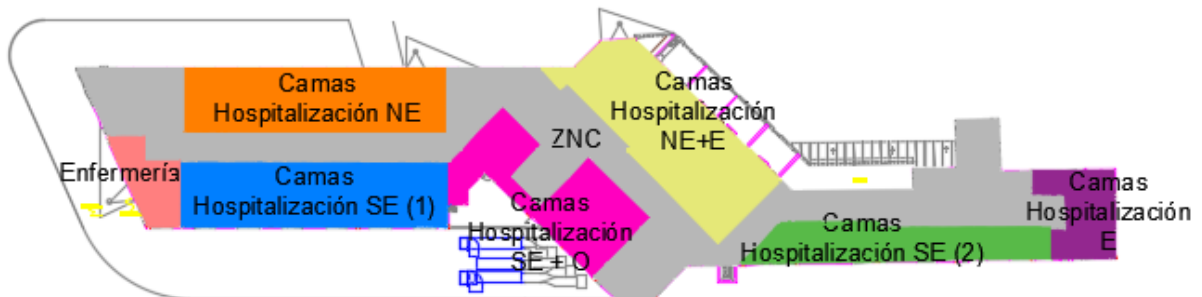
Anexo I. Zonificación planta 1 (fuente: elaboración propia).
